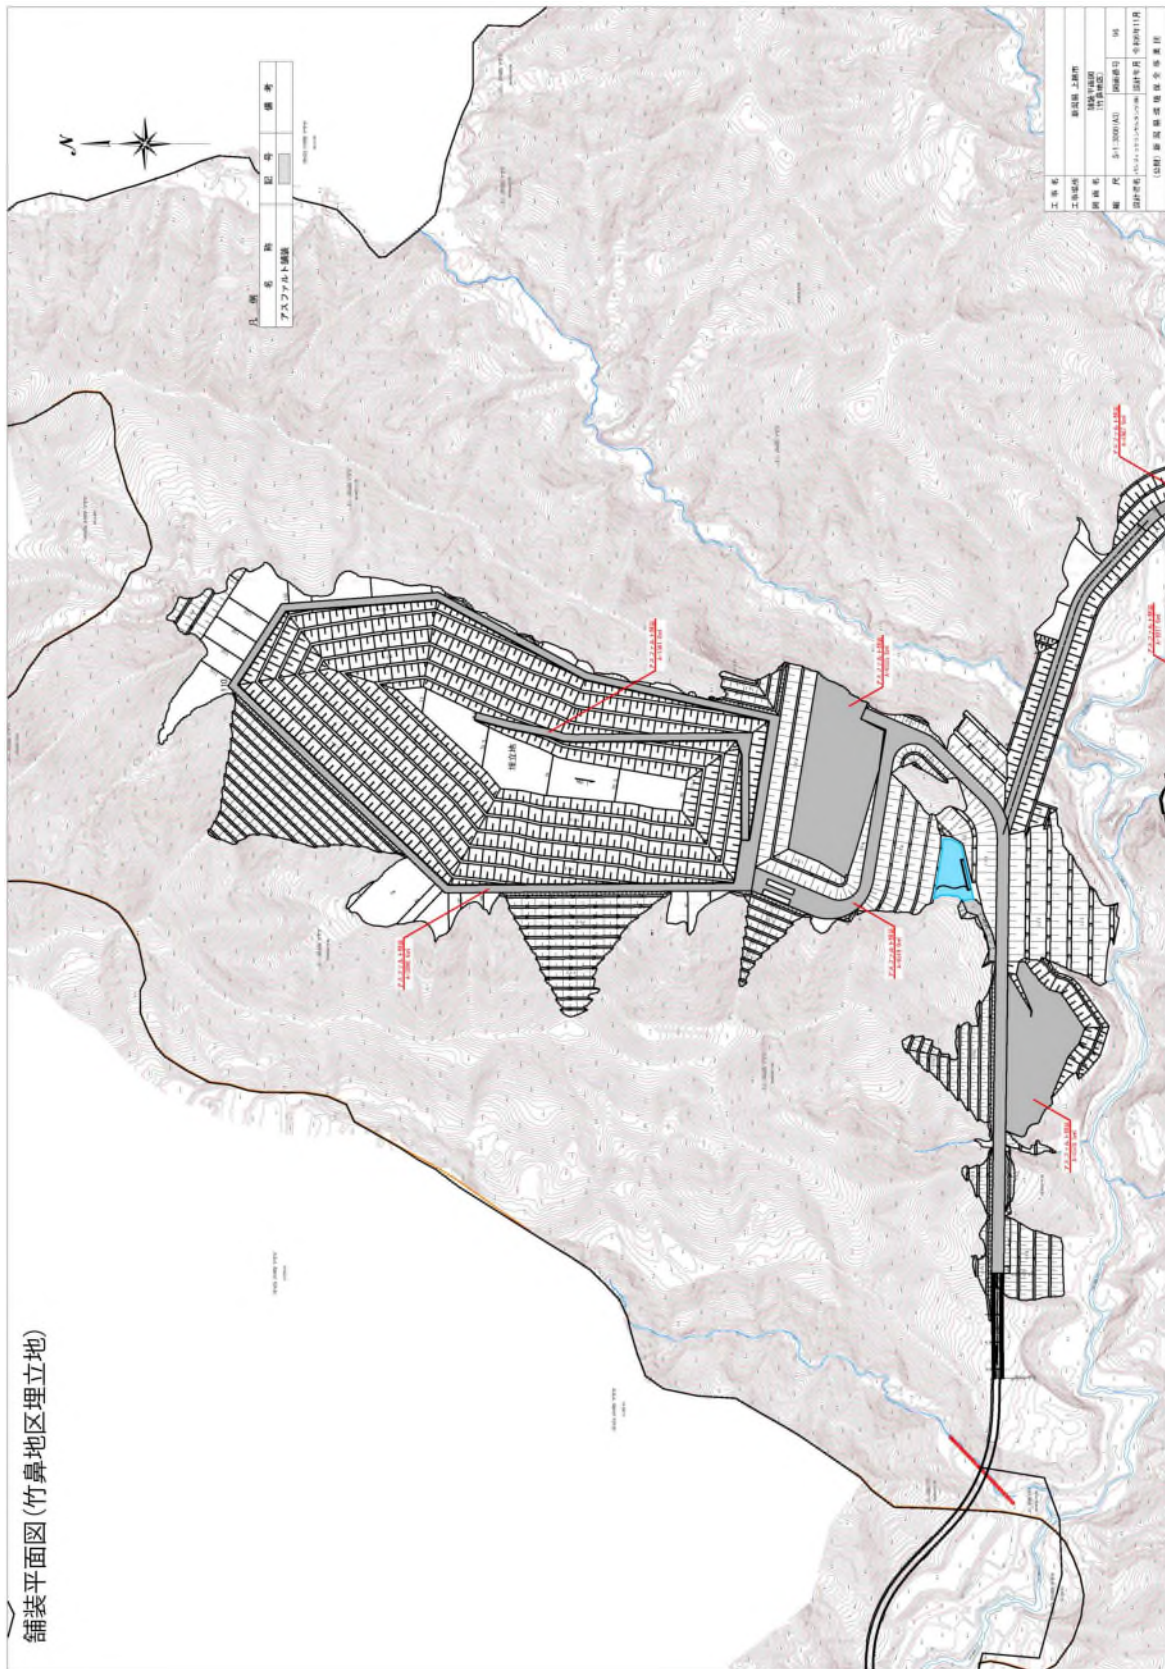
(1) 舗装平面図 (竹鼻地区埋立地)
